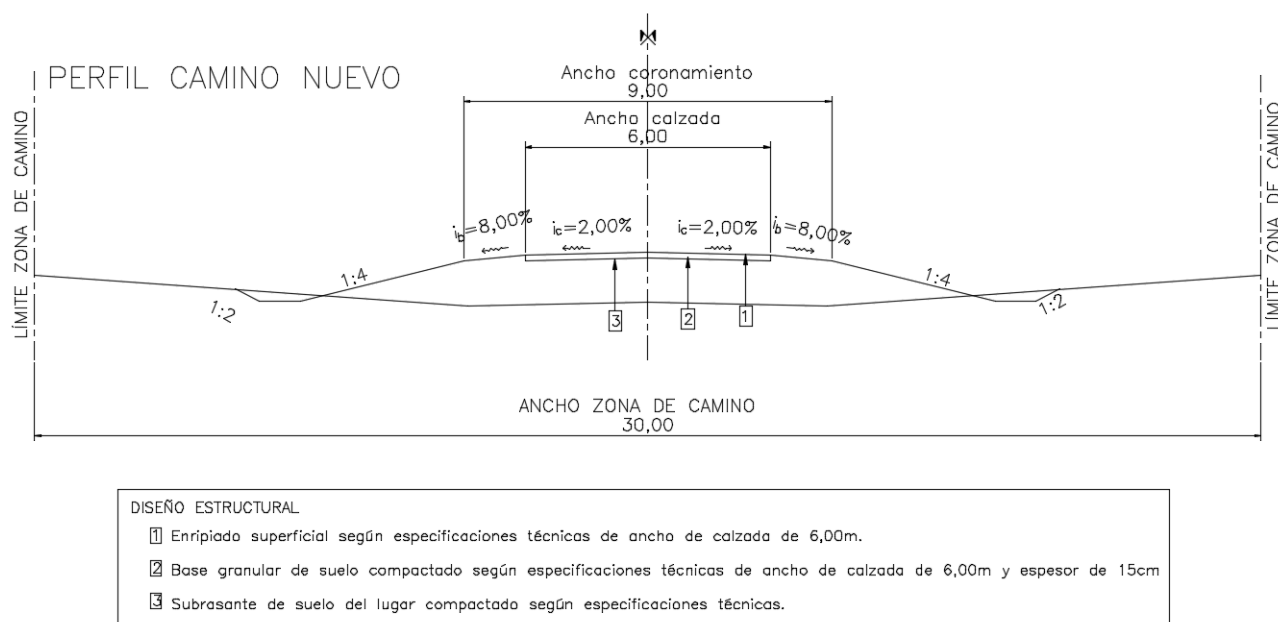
Perfil transversal tipo del camino. Fuente: Elaboración propia.
